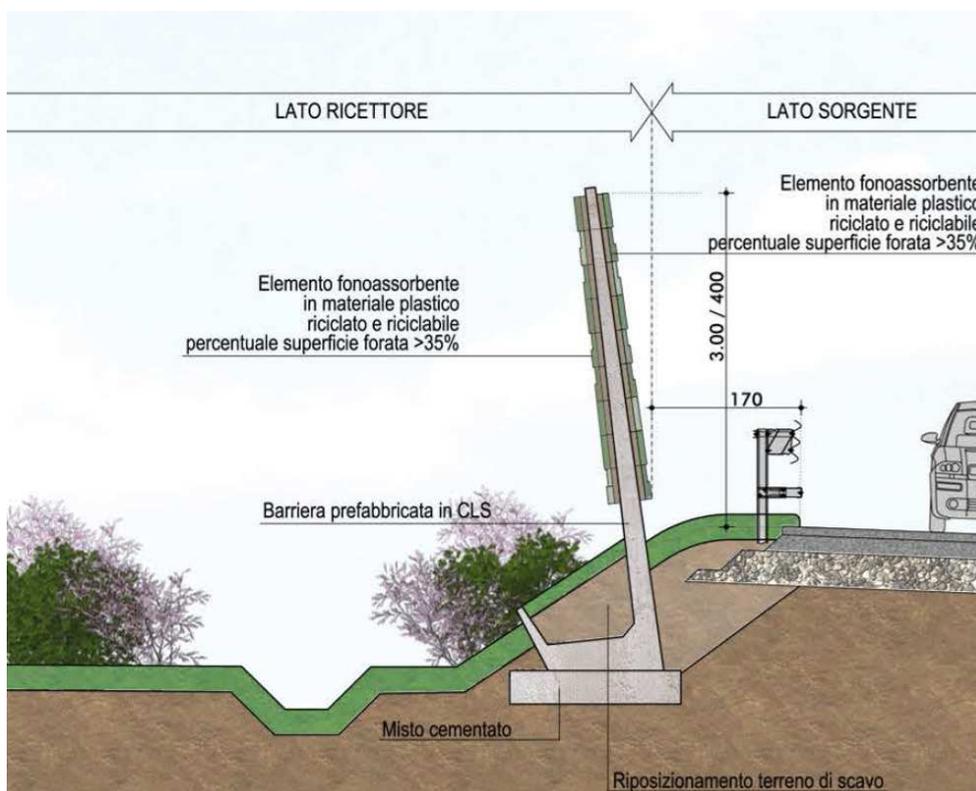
ESEMPIO DI SEZIONE TIPO CON BARRIERA OPACA FONOASSORBENTE SIA LATO SORGENTE CHE LATO RICETTORE
